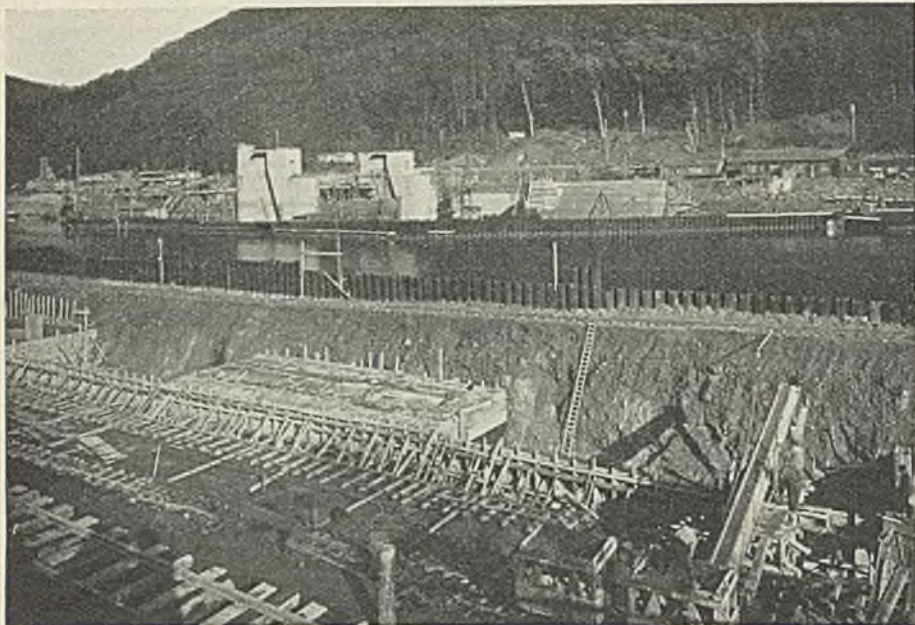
Staustufe Neckargemünd, Schleusenbaugrube und rechtseitige Wehroffnung nebst Einlauf zum Kraftwerk.
